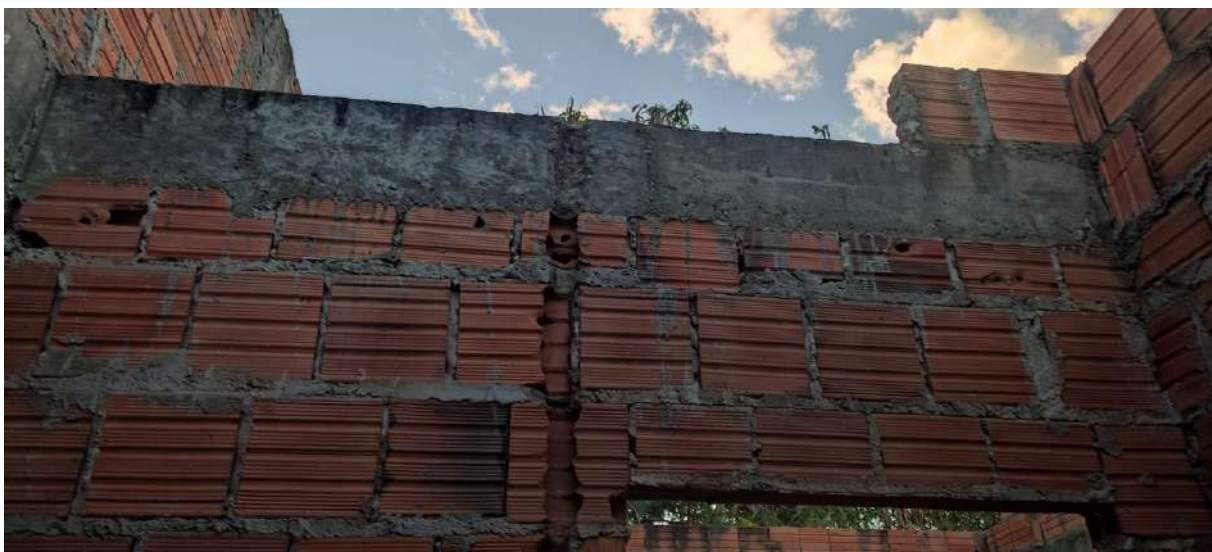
1- Verga não executada. 2- Viga perfurada para passagem de tubulação. Fonte: elaboração própria
